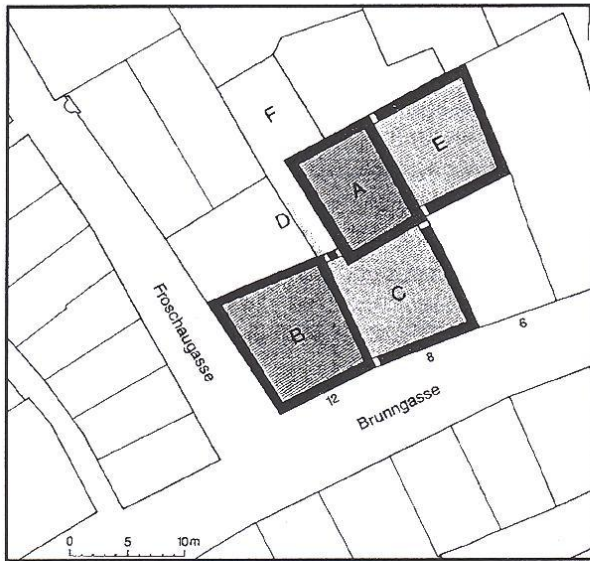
Grundrissentwicklung der Häuser Brunngasse 6-12 (BdD, S. 30)
